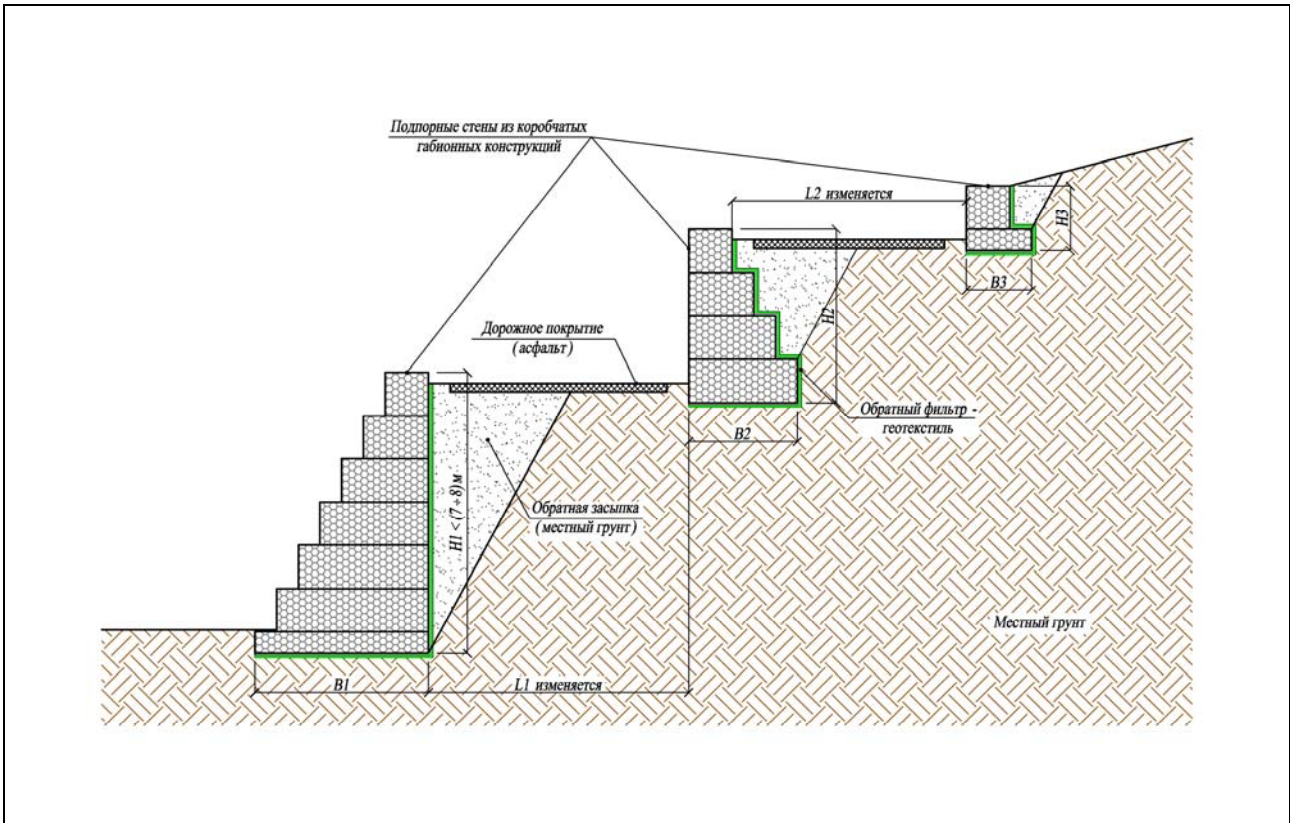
Схема комплекса подпорно-удерживающих сооружений из коробчатых габрионных конструкций
